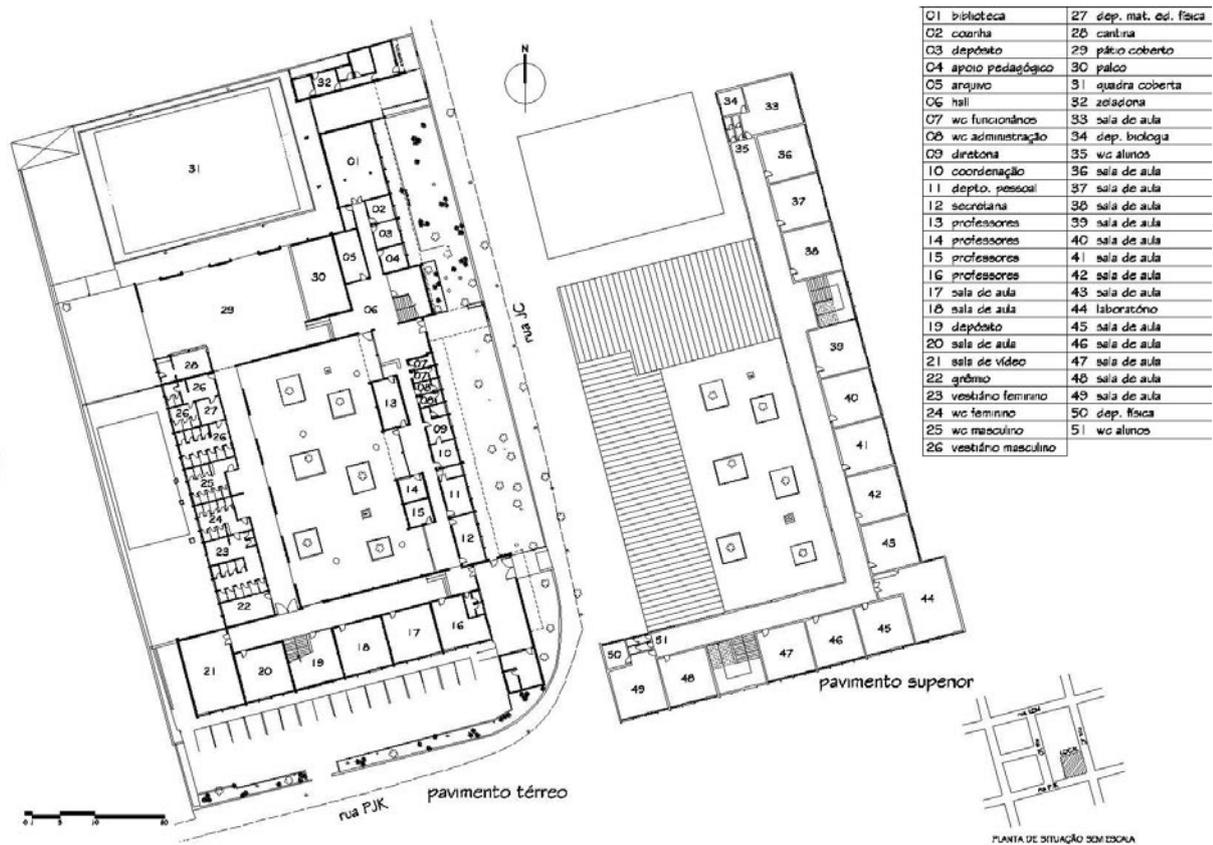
PLANTA CADASTRAL DA ESCOLA A (atualizado em Novembro de 2004)
